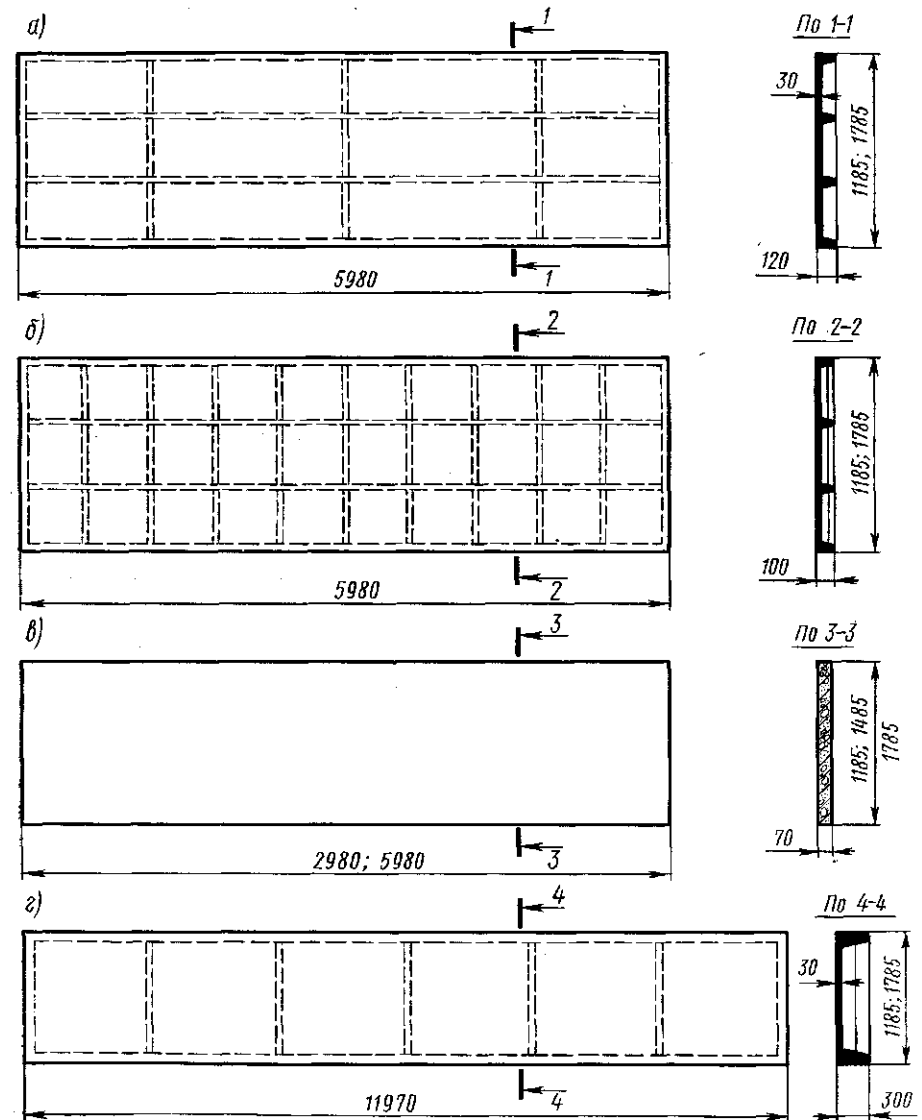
Железобетонные панели для стен неотапливаемых зданий:
